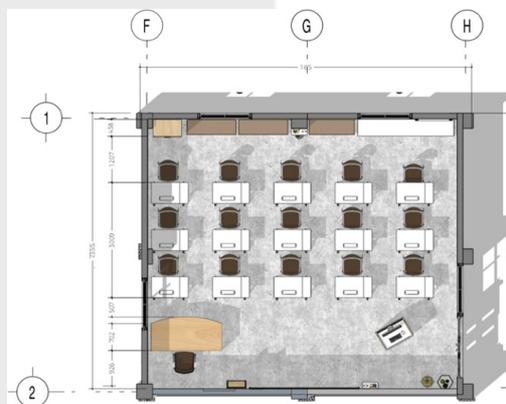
Sirkulasi Ruang Kelas Teori
